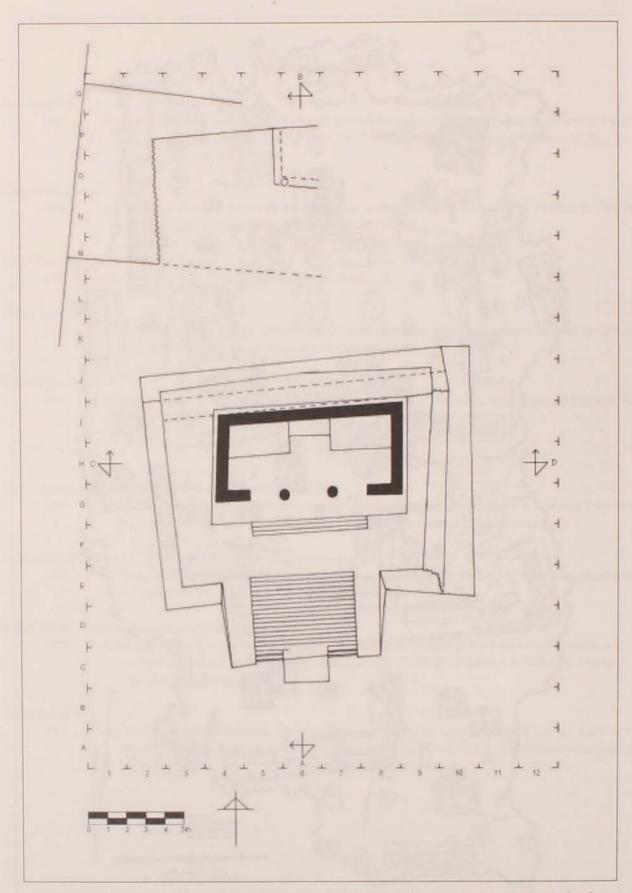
Planta arquitectónica de la Estructura Q.141 de Mayapán. Dibujó Pedro Delgado.
